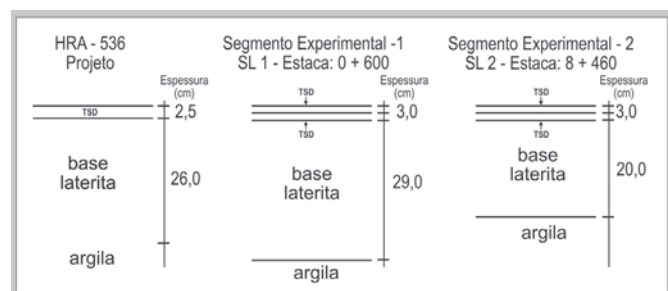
Estrutura do pavimento da ERS-536 prevista em projeto e encontrada in situ
